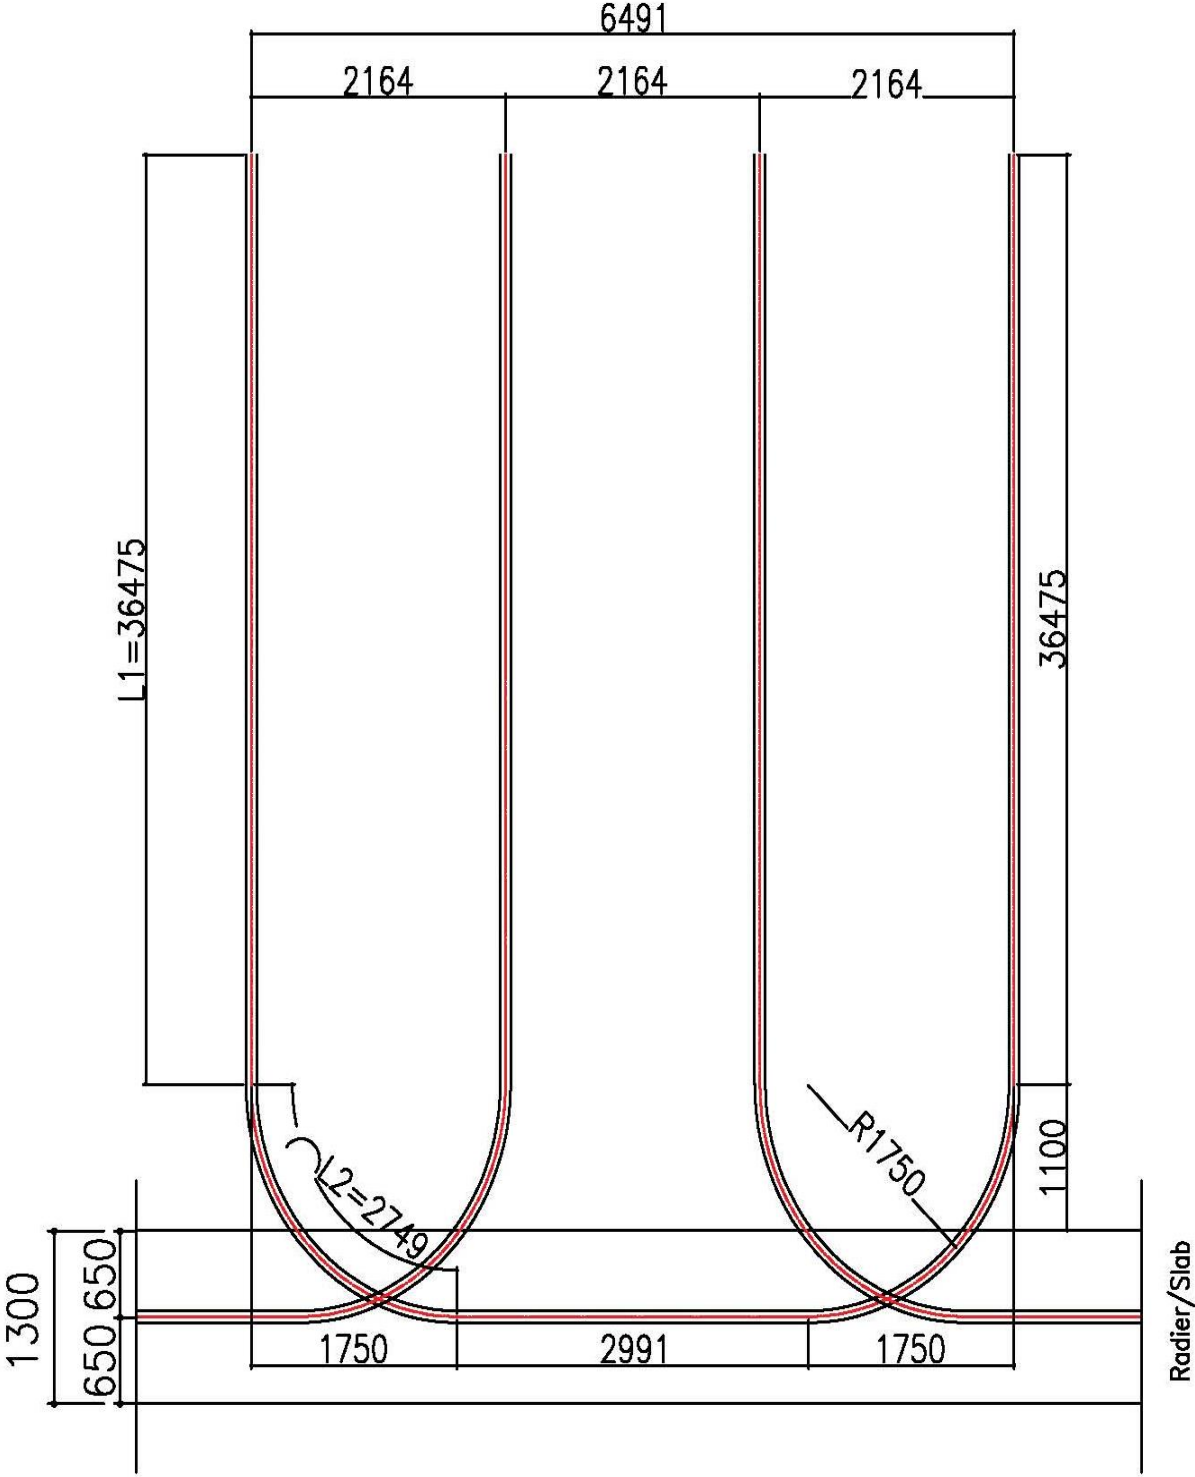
Coupe type sur bossage en zone courante de la jupe et au niveau de la poutre annulaire.
